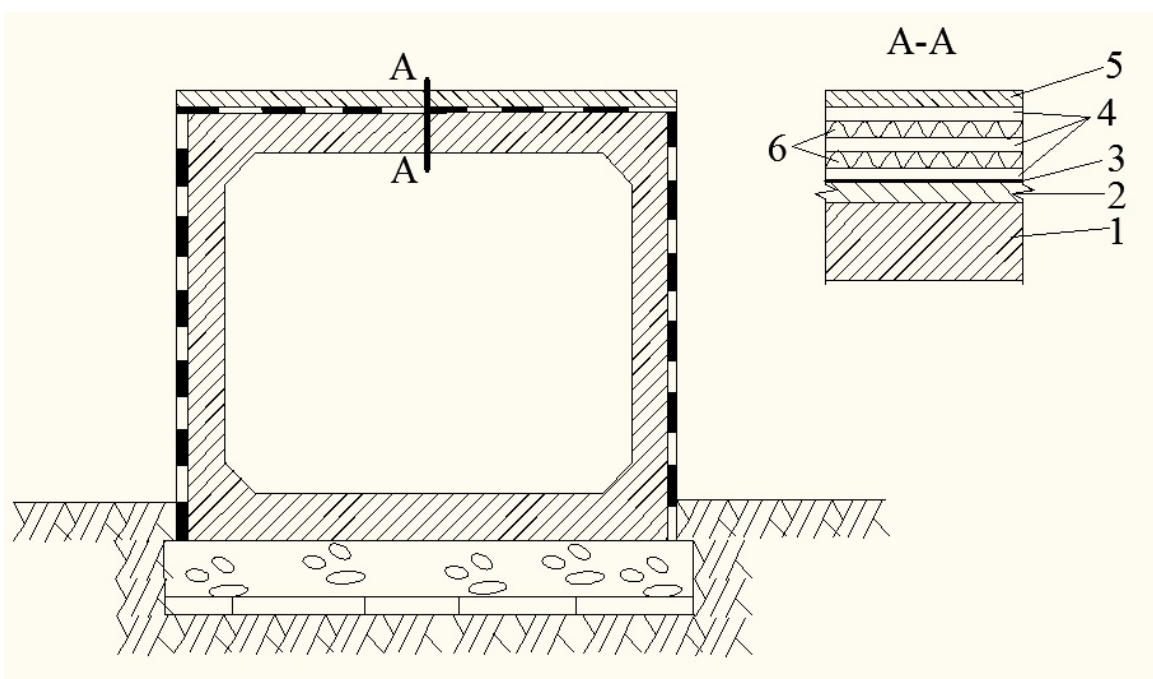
Гидроизоляция типа БМ-1 для сборных железобетонных прямоугольных водопропускных труб: 1 – звено трубы; 2 – подготовительный слой; 3 – битумная грунтовка; 4 – три слоя битумной мастики толщиной 1,5 мм каждый; 5 – защитный слой толщиной 30 мм цементобетона марки М-150; 6 – два слоя армирующего материала между ними
